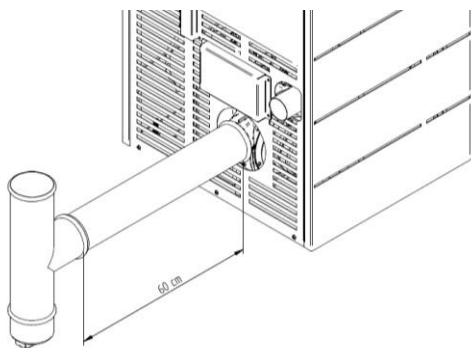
Instalação de um T inspeção a 60cm da saída do equipamento
